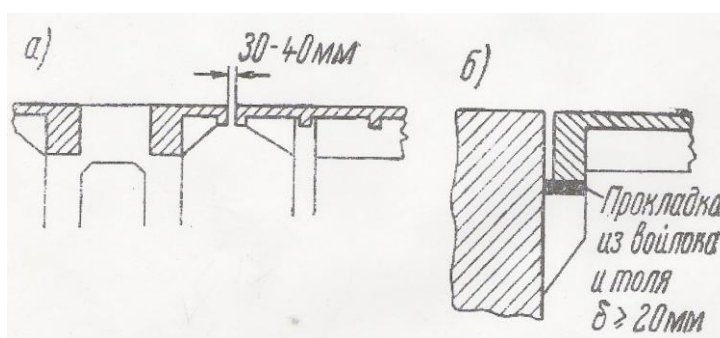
Схемы примыкания к рамному фундаменту перекрытия над подвалом
